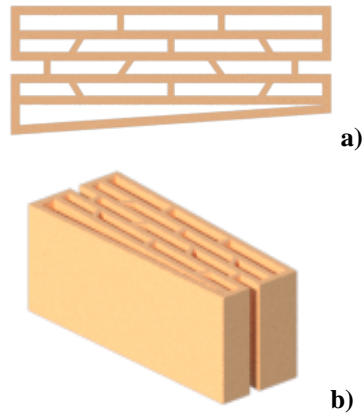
Diseño Unidad Constructiva: (a) Planta (b) Isometría.
